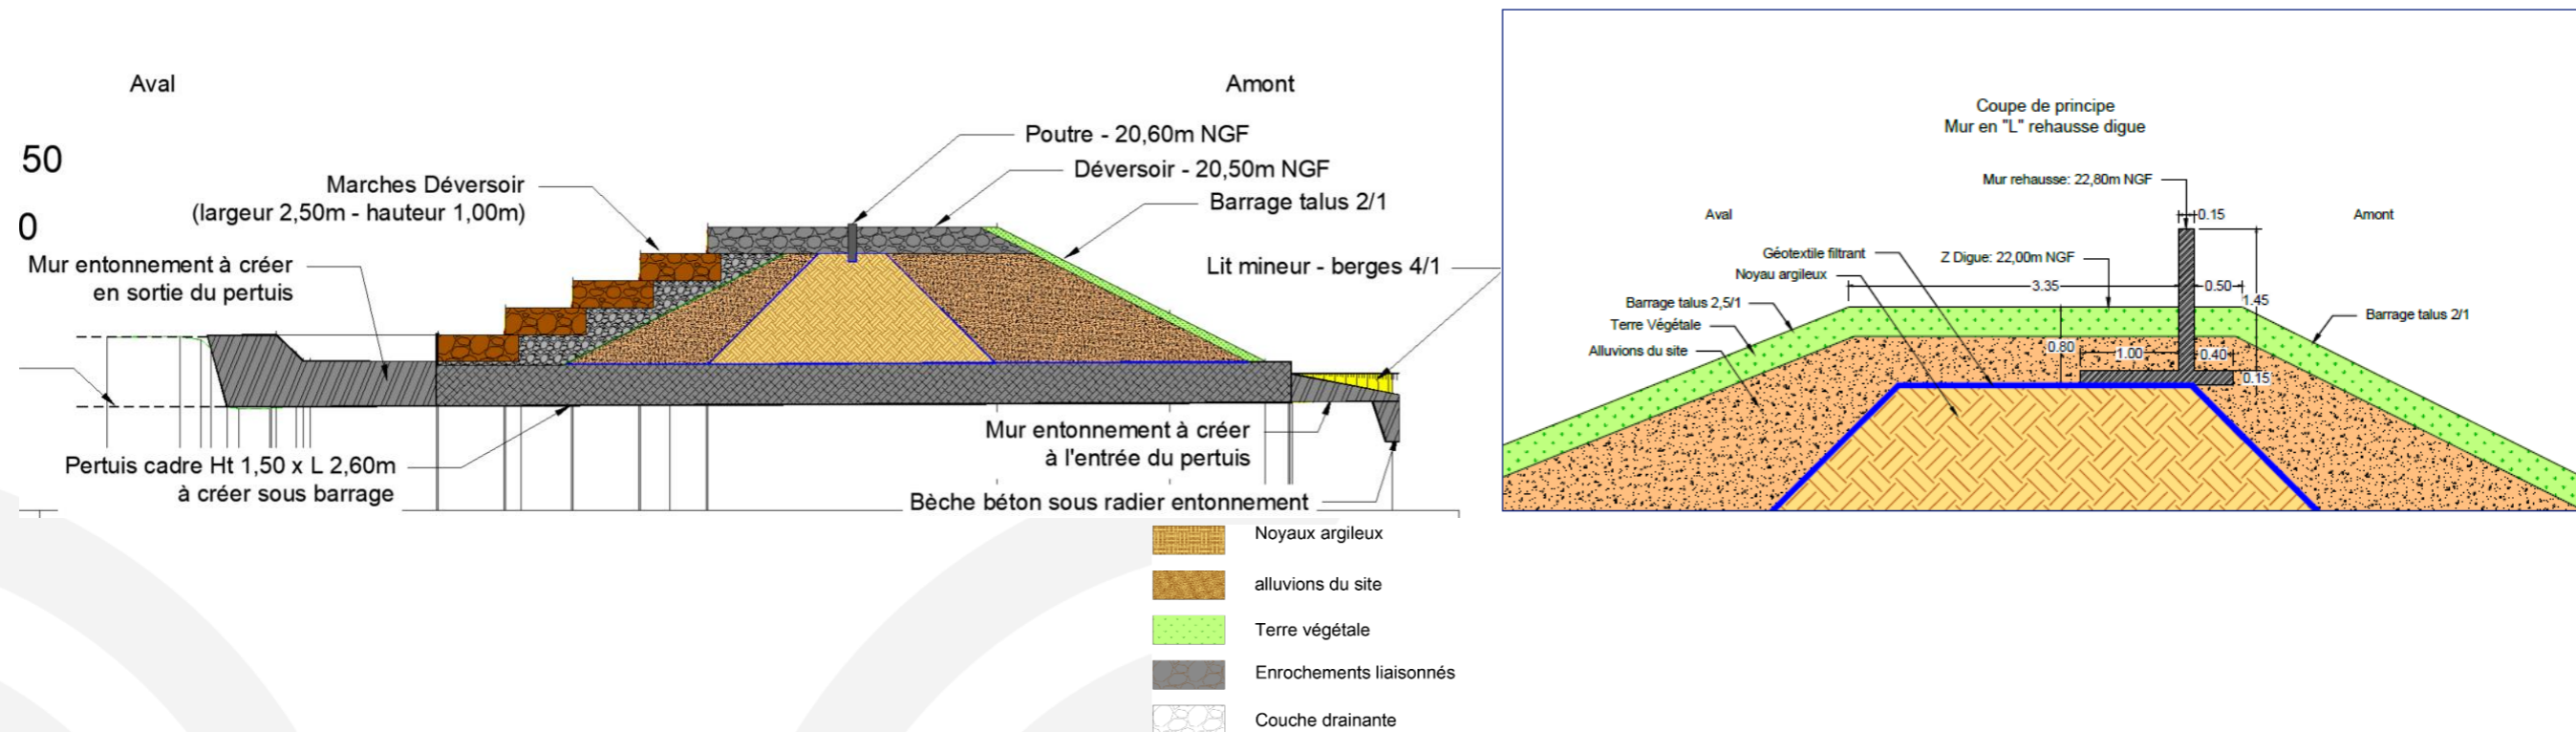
Coupe B-B' à gauche, et de la section courante en rive droite à droite – plan AVPI
